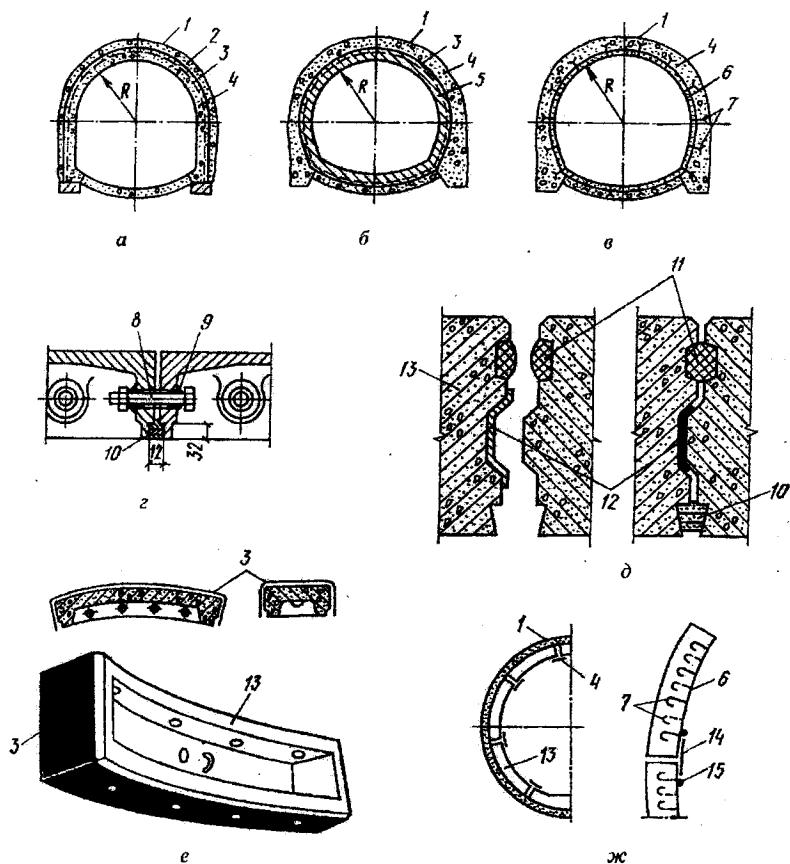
Гідроізоляція монолітних (а-в) і збірних (г-ж) конструкцій підземних споруд, що будуються закритим способом: 1 – контур виробки, 2 – набризг-бетон; 3 – обклеювальна ізоляція; 4 – кріплення; 5 – залізобетона обійма, 6 – металоізоляція; 7 – анкери; 8 – болт; 9 – гідроізоляційна шайба; 10 – карбувальна канавка; 11 – гумова прокладка; 12 – заповнювач з пластику; 13 – залізобетонний блок, 14 – накладка, 15 – зварний шов
